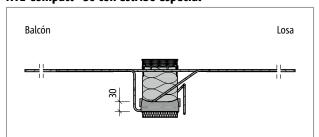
Schöck Isokorb® XT tipo K-M7 hasta M10: Sección del producto
